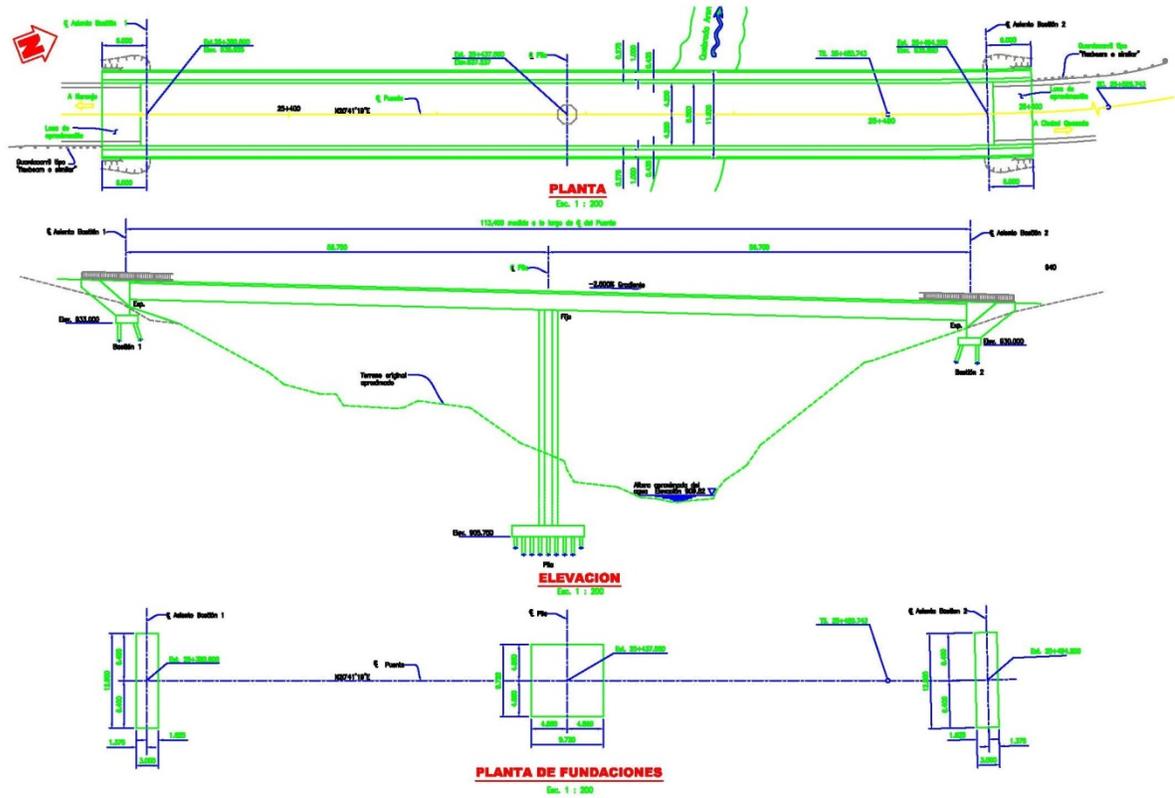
Plano sobre el puente sobre la Quebrada Arena donde se identifican sus elementos.
